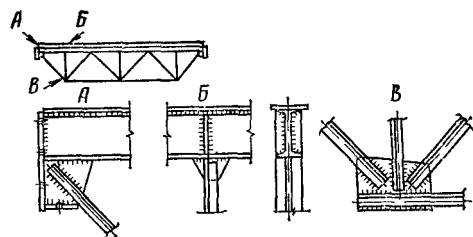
Сварные узлы подкрановых ферм
